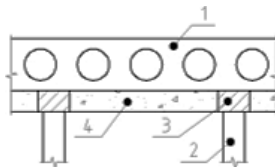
Конструктивная схема фундамента с раздельным сопряжением свай и плиты-ростверка:
